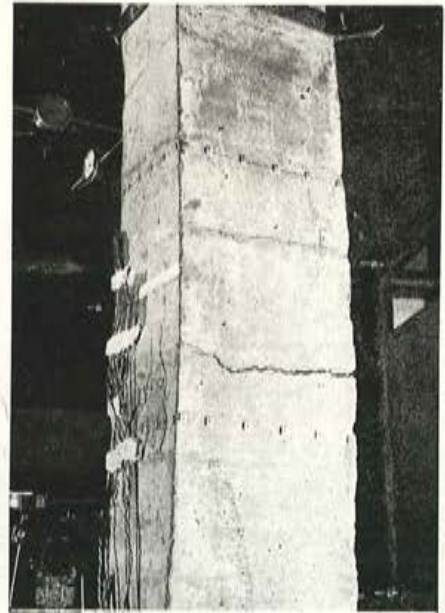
Detalle de fisura en la zona de tracción. Puntos de medida.
